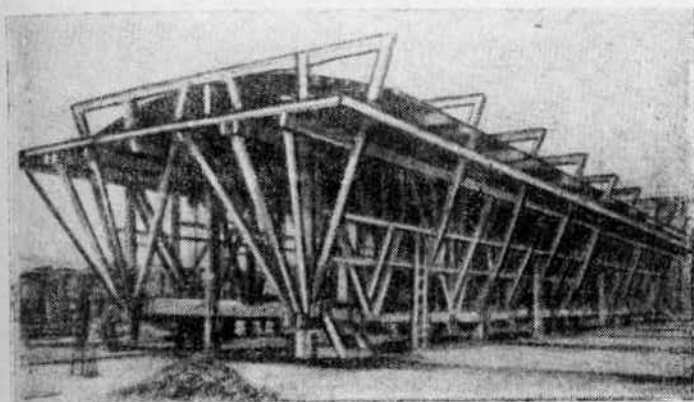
Здание с конструкциями из цельножелезобетонного монолитного каркаса и покрытием в виде короткой оболочки
